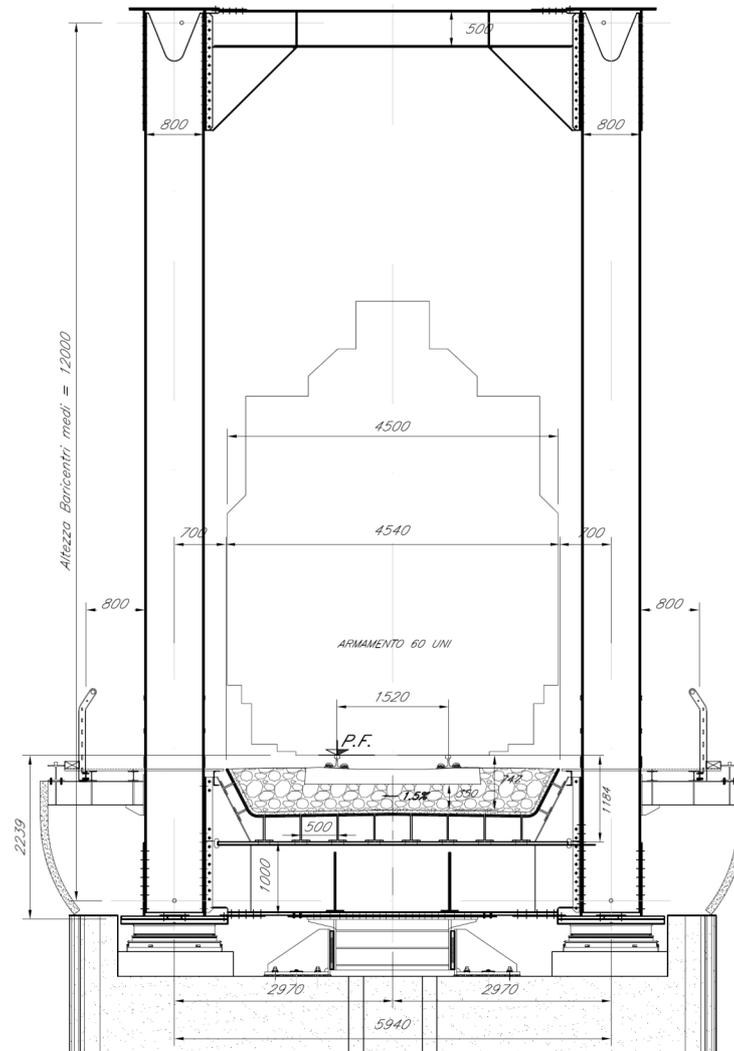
Sezione trasversale campata in acciaio L=70 m
